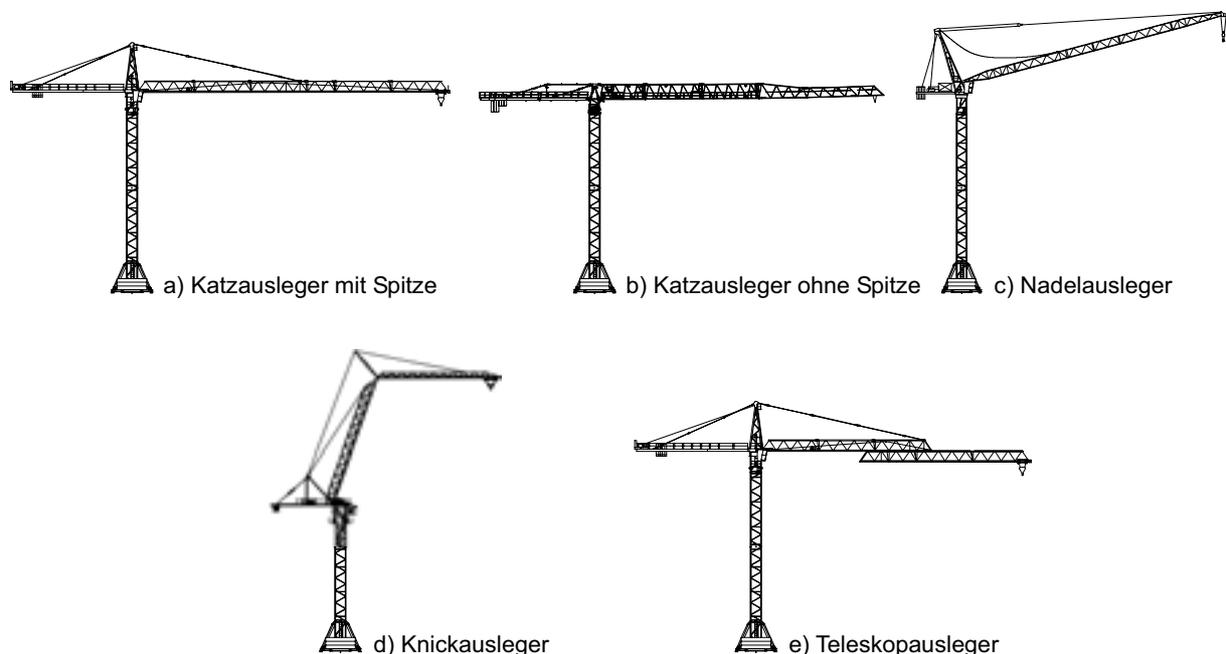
Auslegerbauformen Obendreher [Gün-04a]
